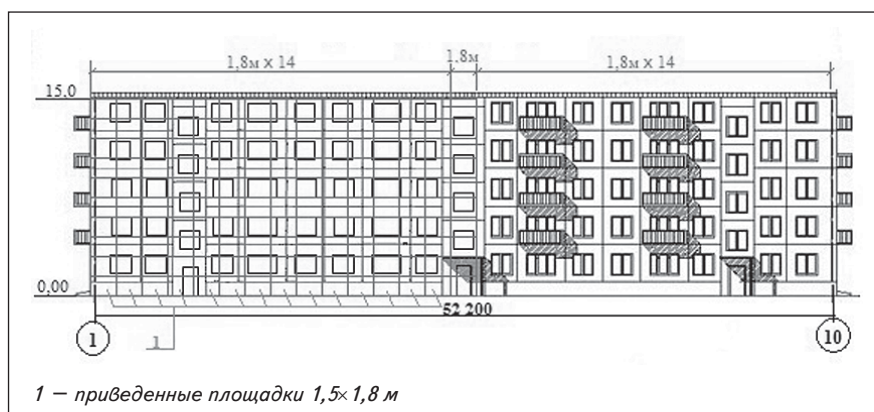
Разбивка фасада дома серии I-510 (П-17) на приведенные площадки
